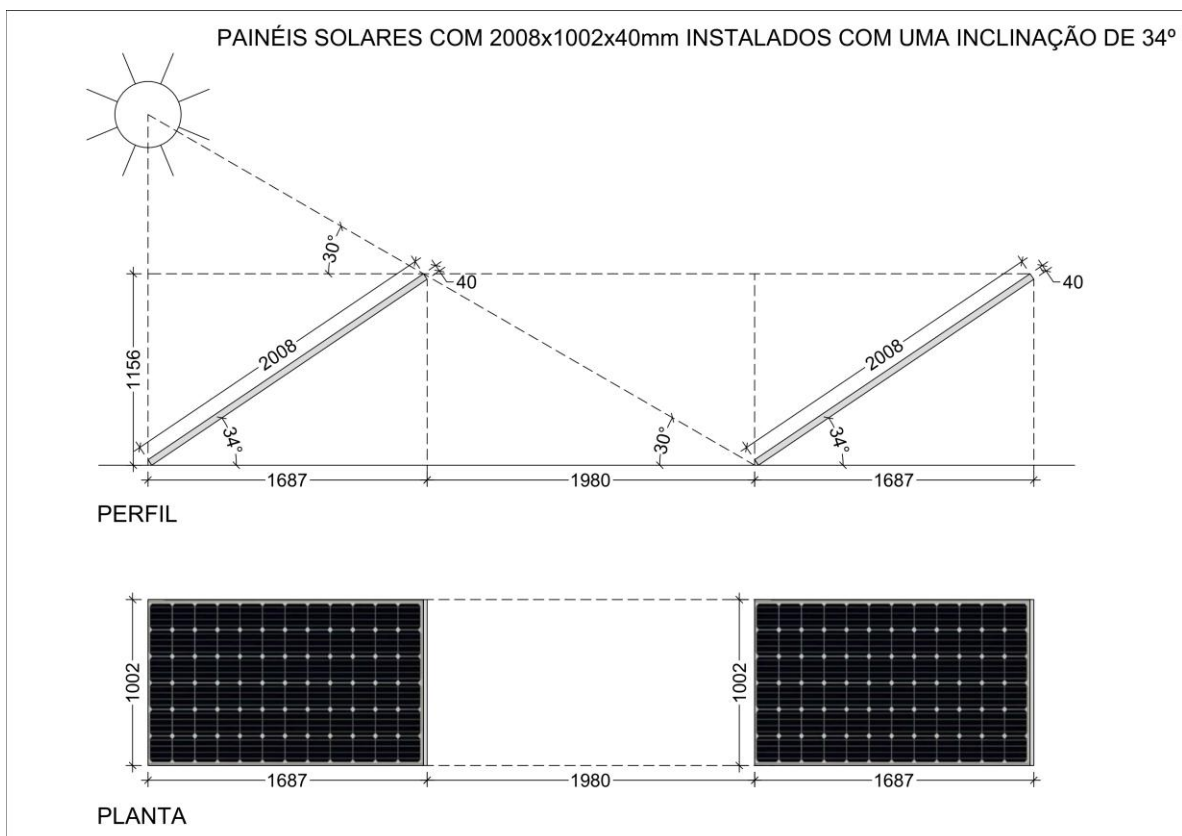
Dimensões de ocupação da área disponível , em planta e perfil (2008 x 1002 x 40mm).
